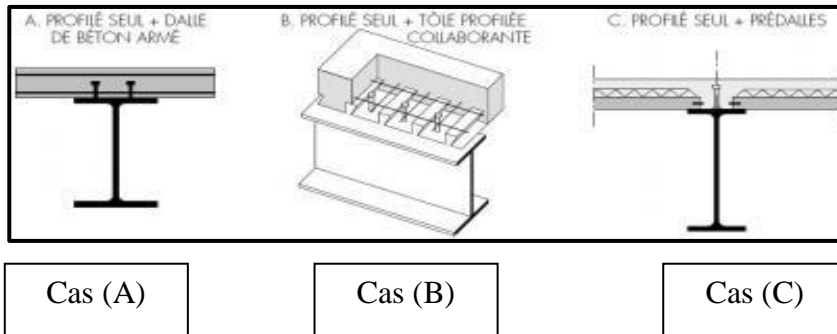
les différents types de plancher dans les poutres mixte.⁴⁰
